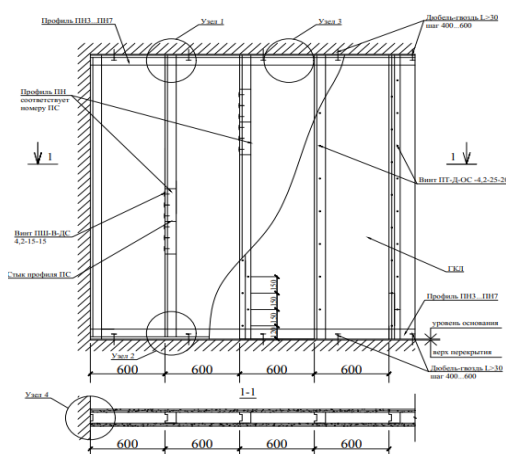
Схема устройства каркасных перегородок из ГЛК
